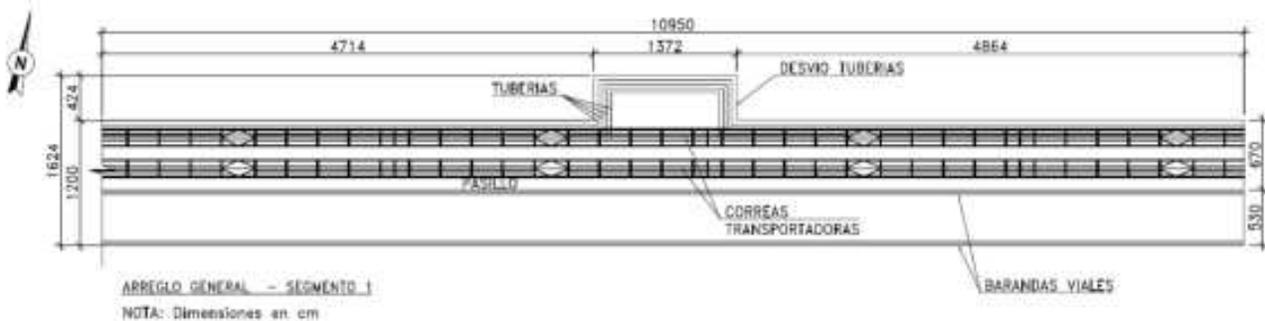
Puente de Acceso – Disposición General – Segmento 1
